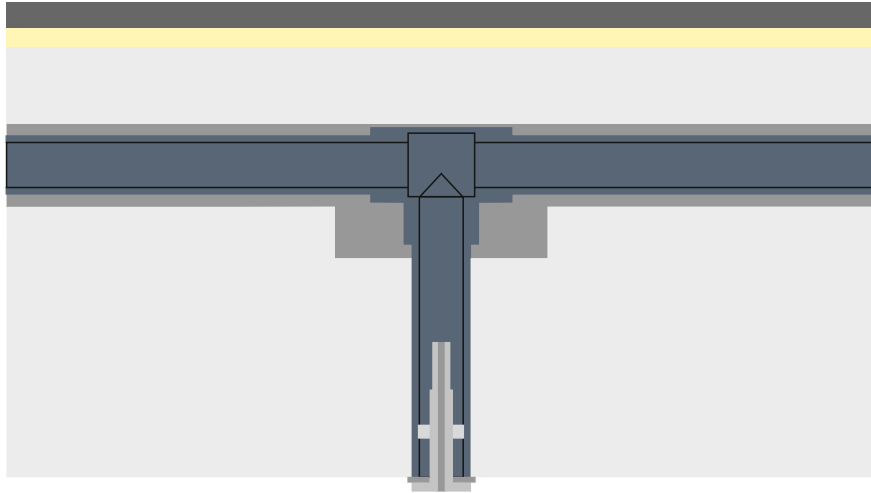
Монтаж аспирационной трубы внутри бетонных конструкций здания
